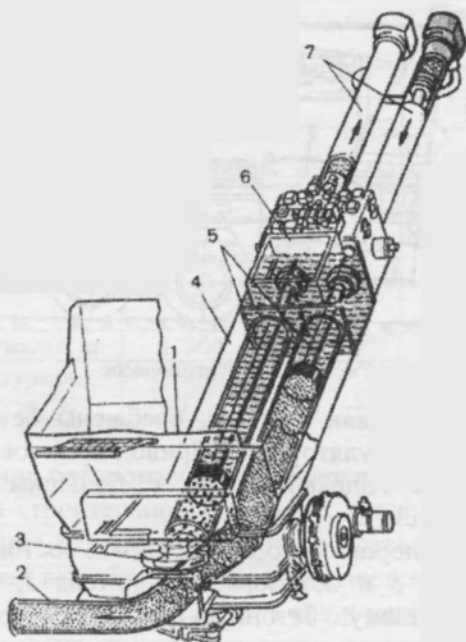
Качающий узел поршневого бетононасоса СБ-126Б
